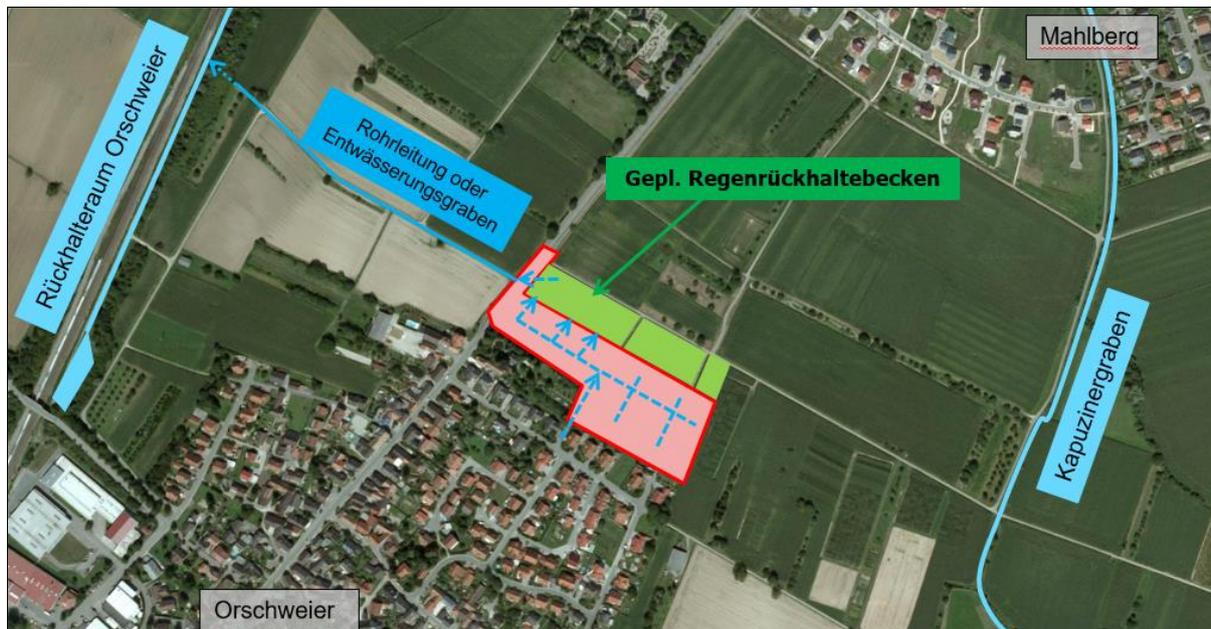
Varianten der Entwässerung (Regenwasser) des Plangebiets
